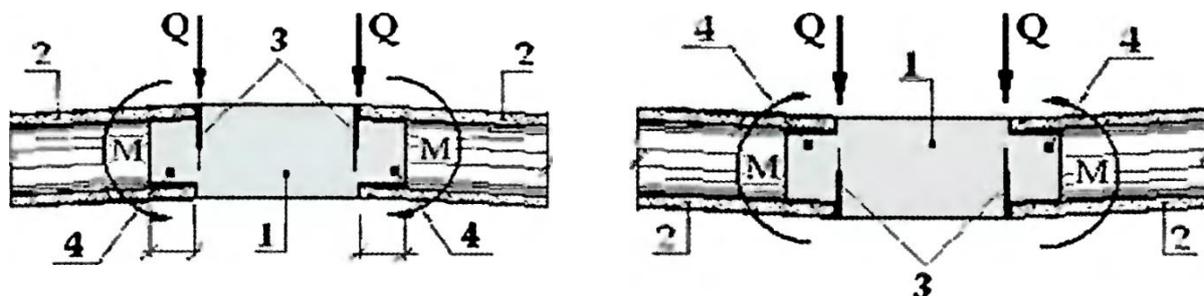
Схема загрузки и излома опорных узлов плит (Примечание: 1 - монолитные железобетонные ригели; 2 - многпустотные плиты; 3 - трещины в бетонных шпонках при повороте опорных сечений плит; 4 - бетонные шпонки глубиной 100...120 мм)
